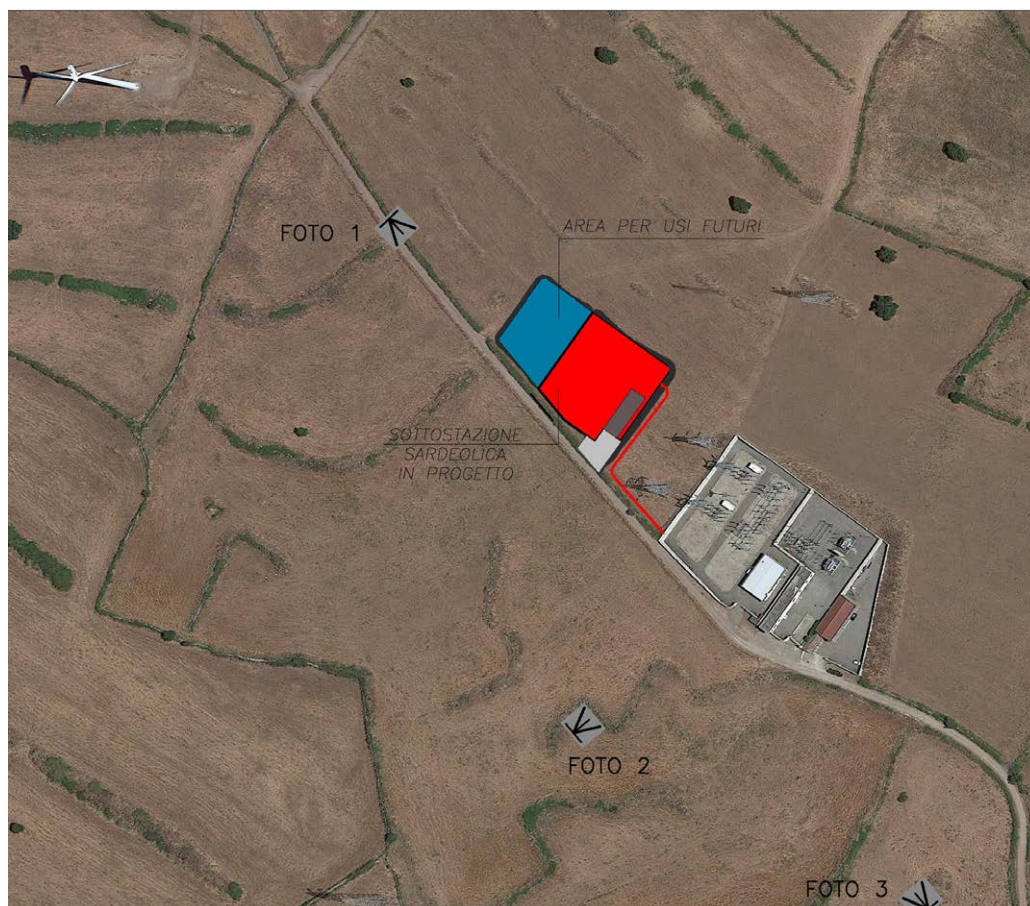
Sovrapposizione area stazioni elettriche con foto aerea
